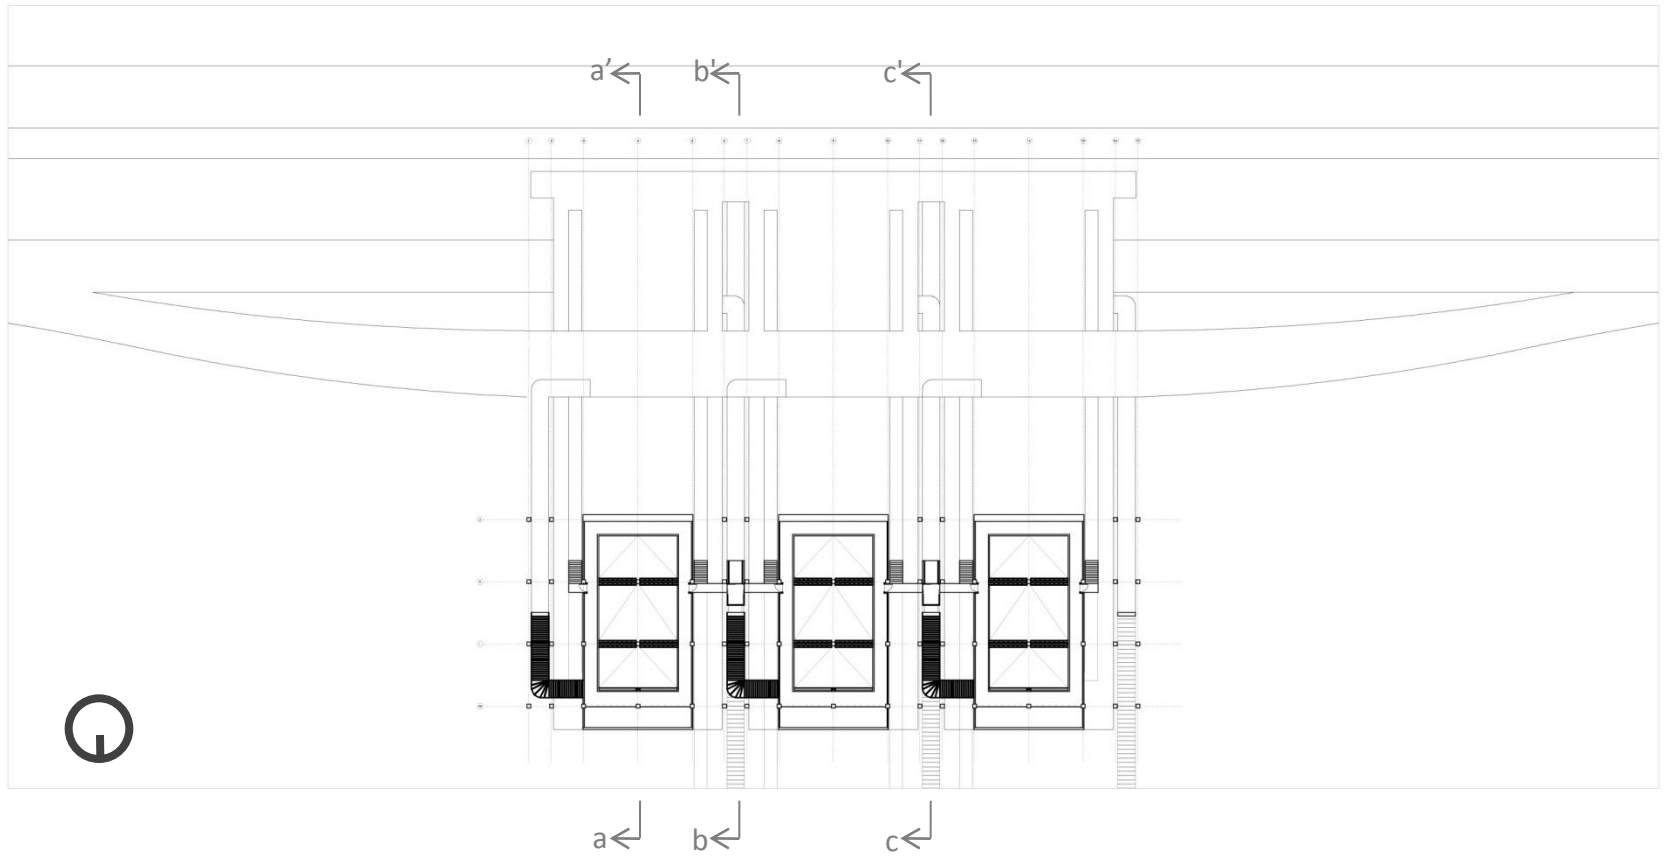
Planta nivel - 4_ Salas de secado bioabono. esc 1:800
